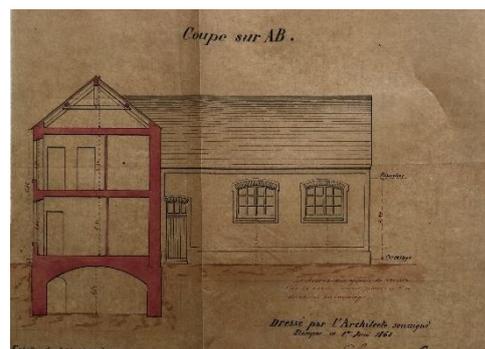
Extrait des plans de construction de la Mairie-École, Archives départementales
